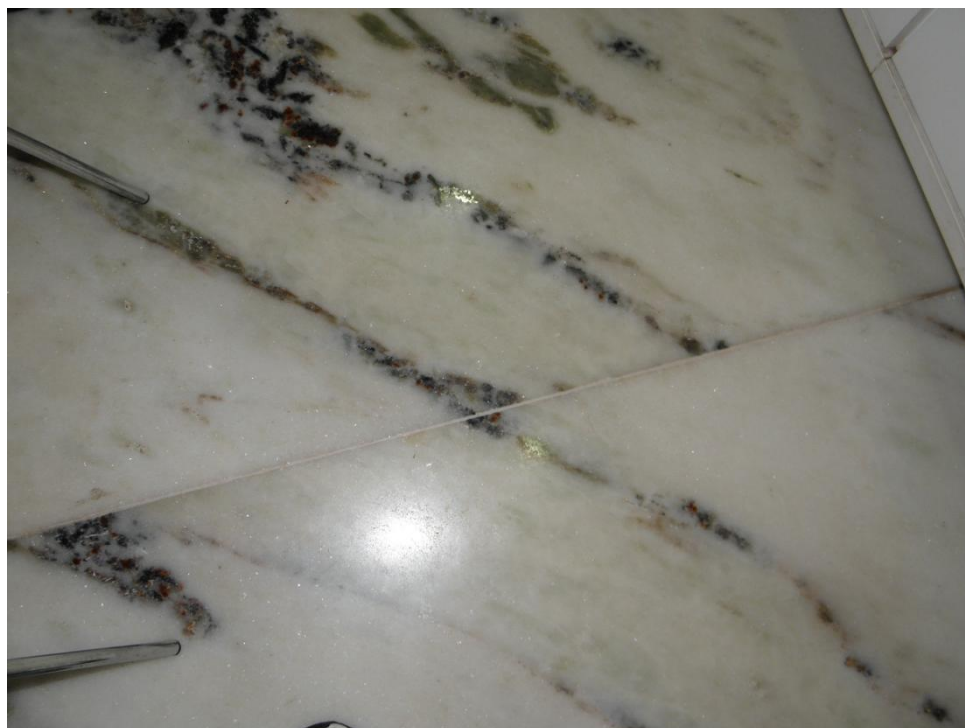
Vista da fissura no piso em mármore da casa da Autora
